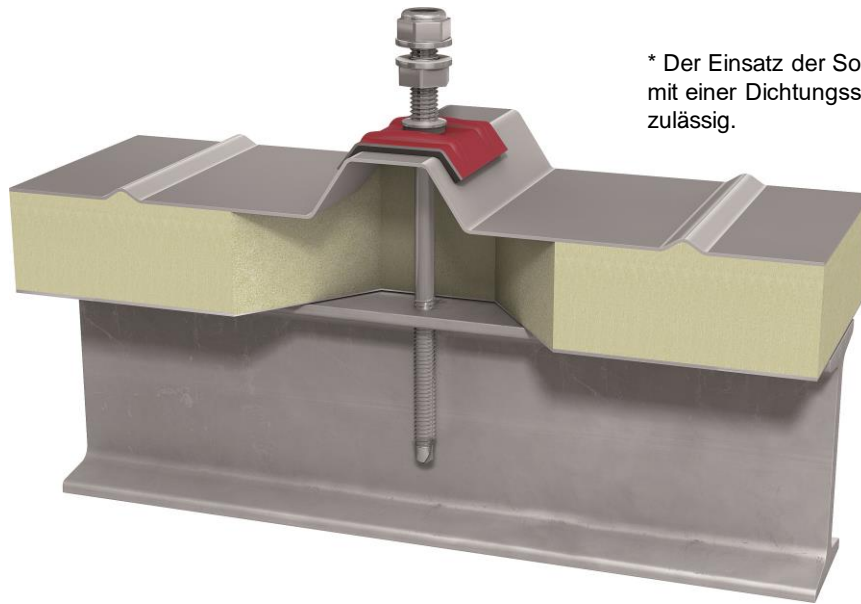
Anwendung Solarbefestiger auf Trapezblech und Stahlträgerkonstruktion
